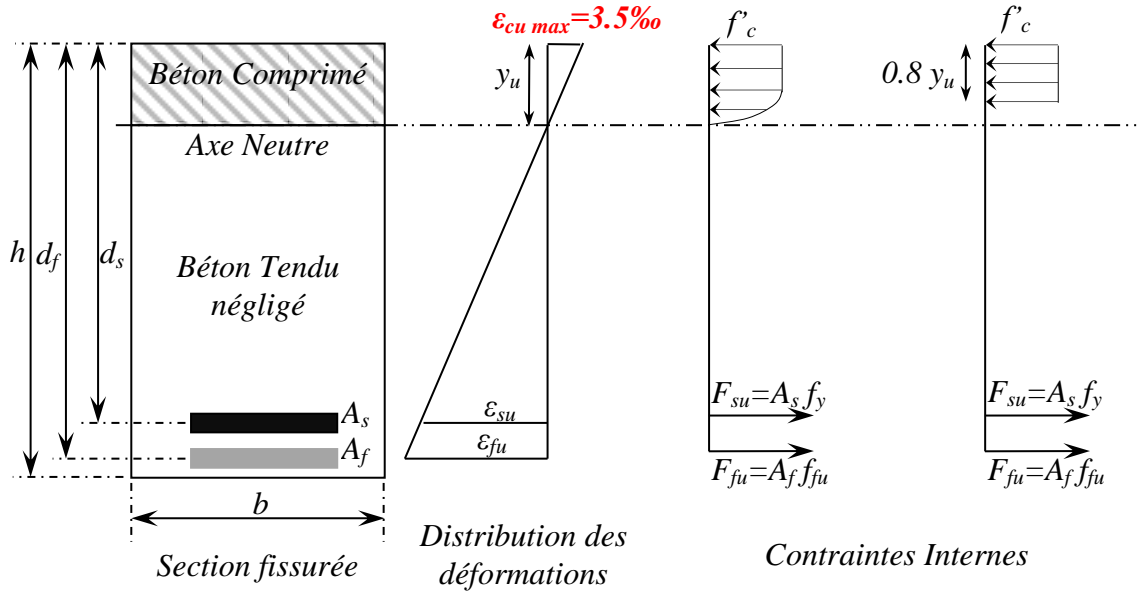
Diagramme de déformations dans la section fissurée à la ruine de poutre par écrasement du béton comprimé.
